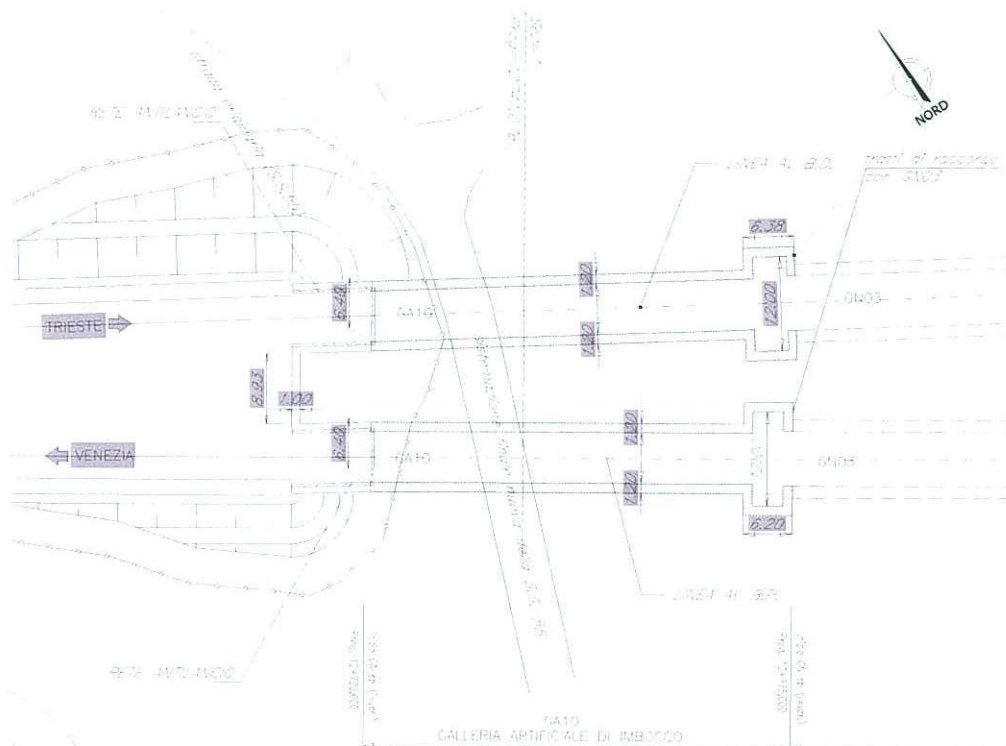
planimetria canne della GA10 e imbocco GN03.
